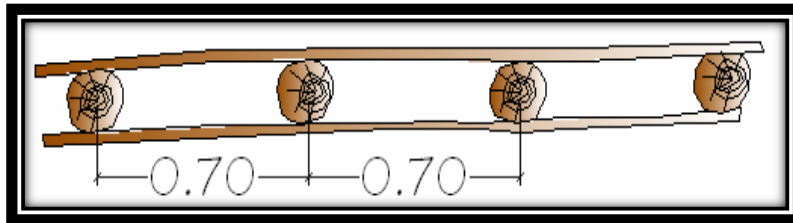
Distancia de Colocación de Varillas de Madera
